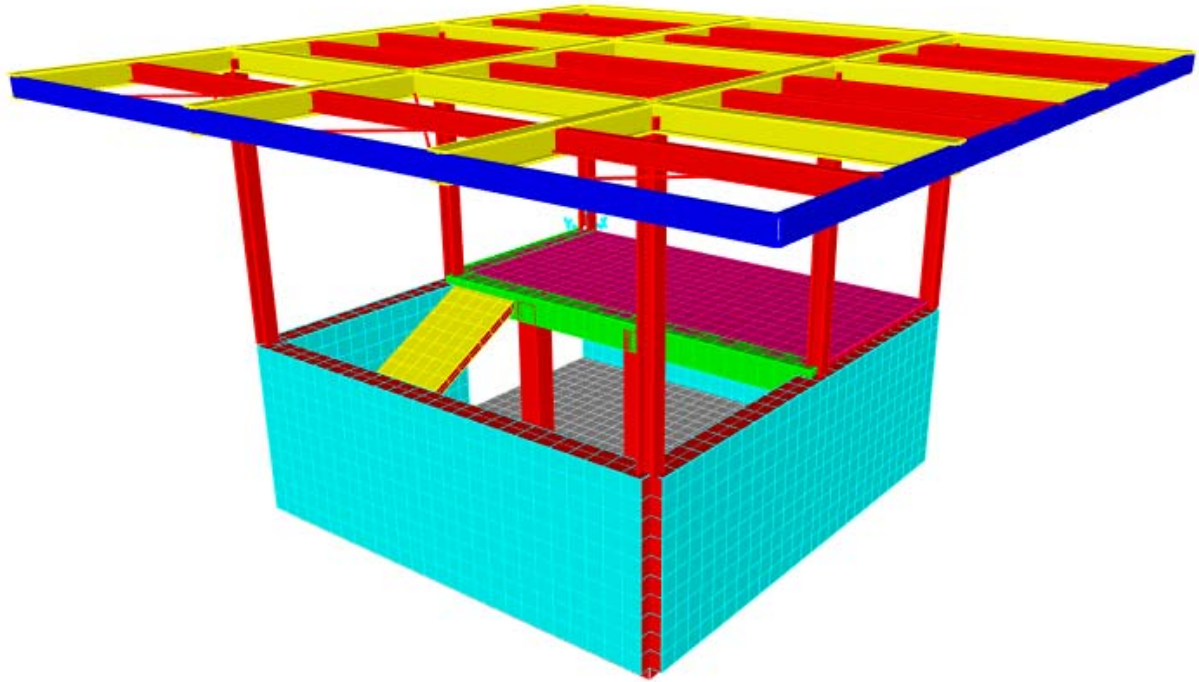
Vista assometrica modello struttura elevazione/fondazione
